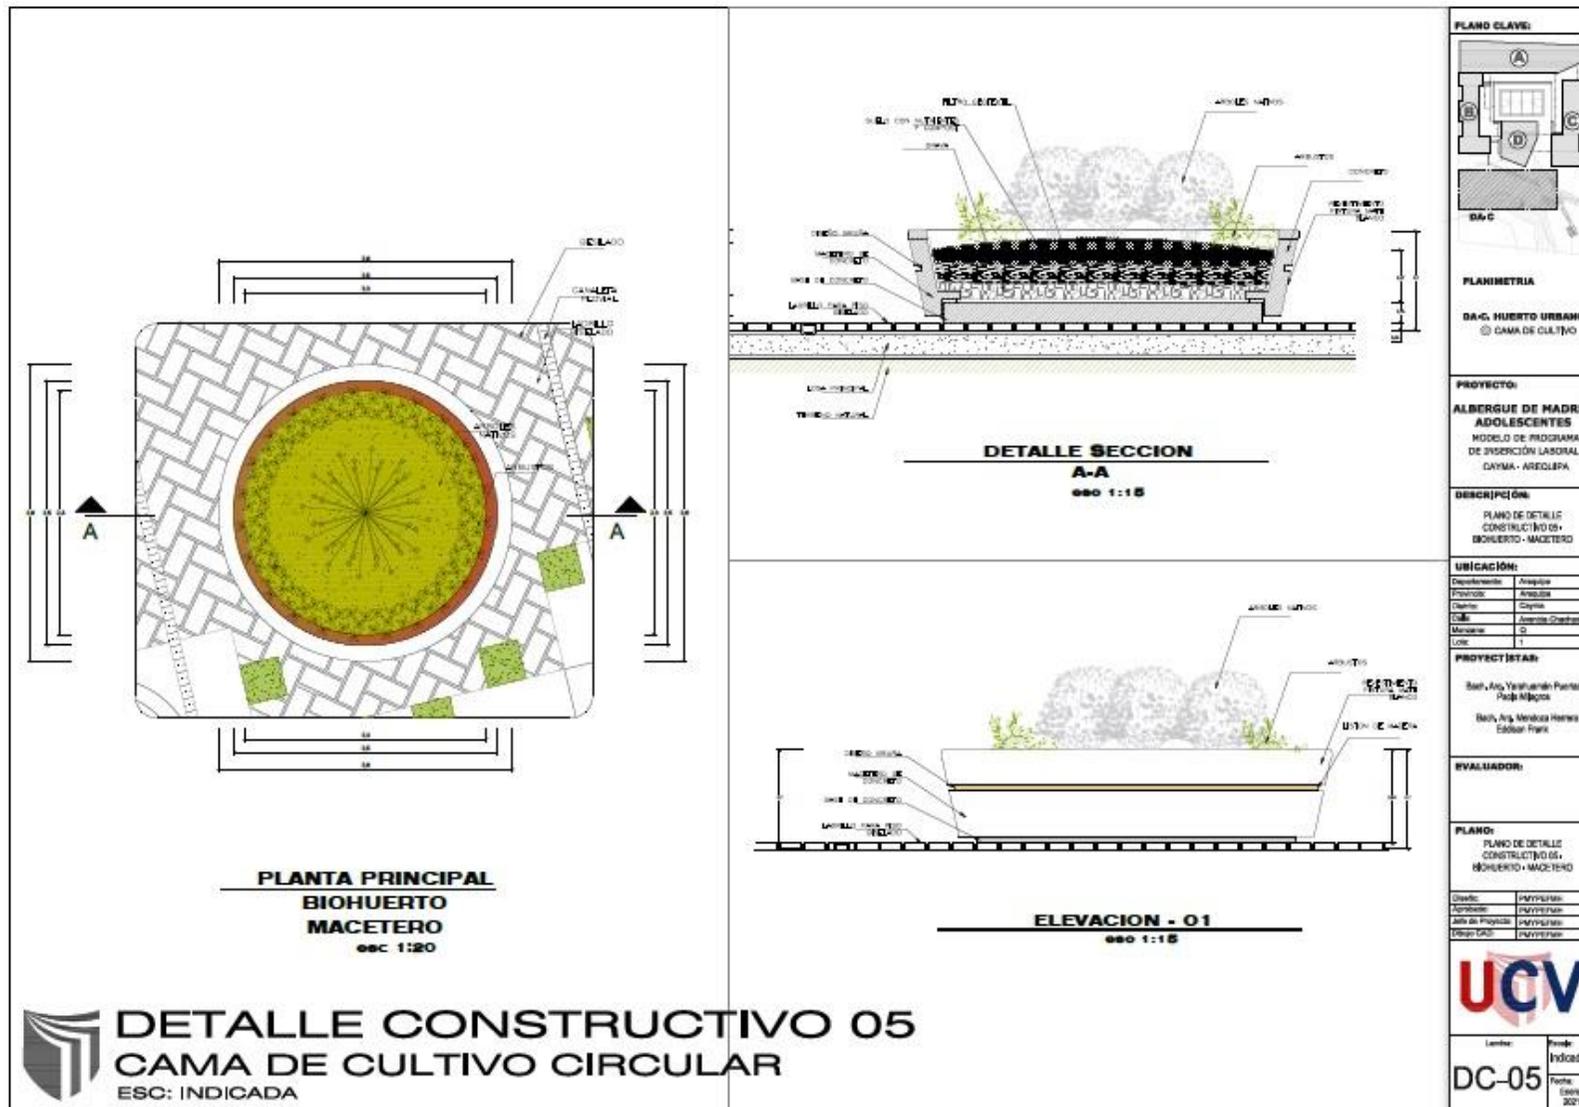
Detalle Constructivo 05 – Cama de Cultivo Circular DC-05.
